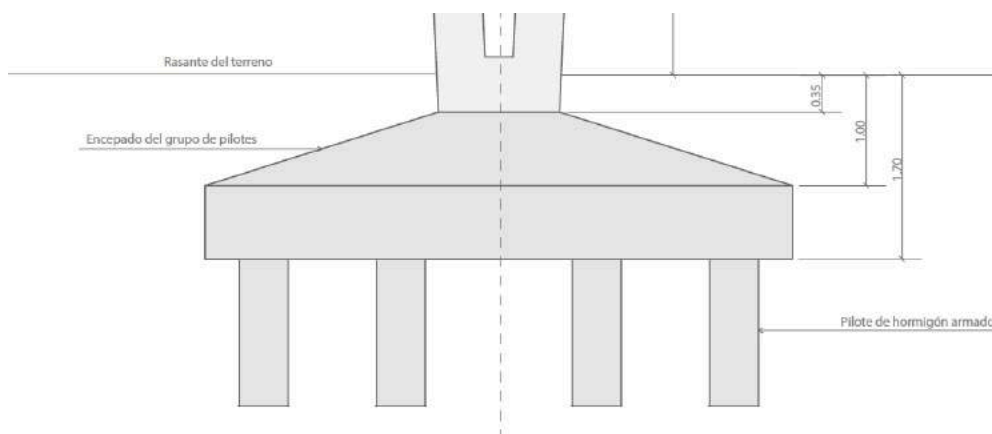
Detalle de la cimentación del recorte del plano “Sección tipo de la pasarela junto con los pilares”
